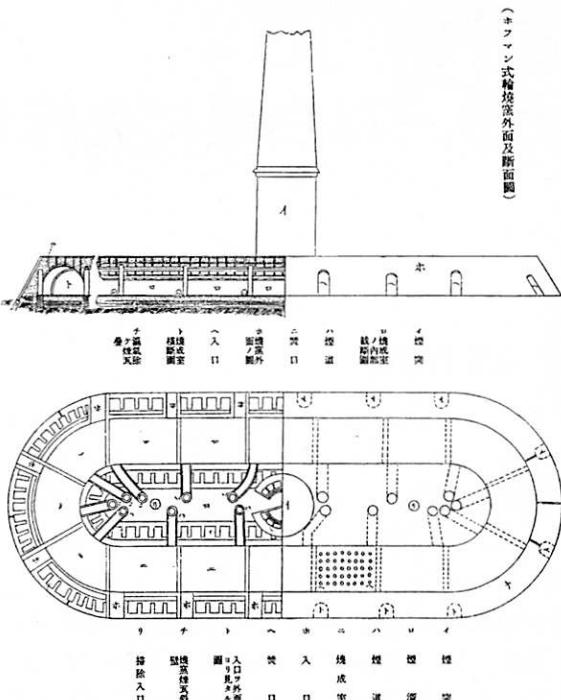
輪窯の構造（上：立面図 下：平面図）（文献1）
